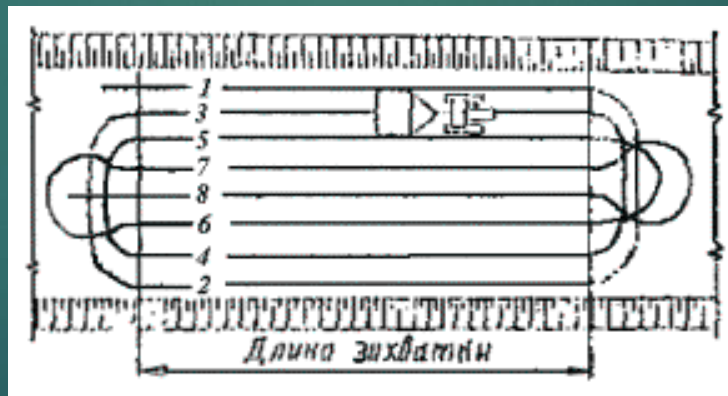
Схема движения трактора с кулачковыми катками:
